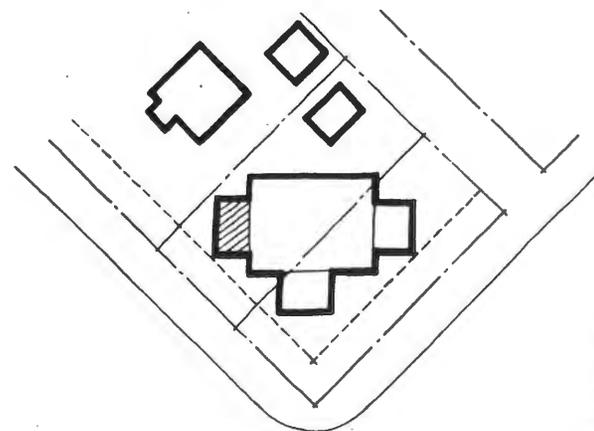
Les rénovations ou constructions de nouvelles annexes à des bâtiments construits en biais à un coin de rue nécessitent un traitement tout particulier.
